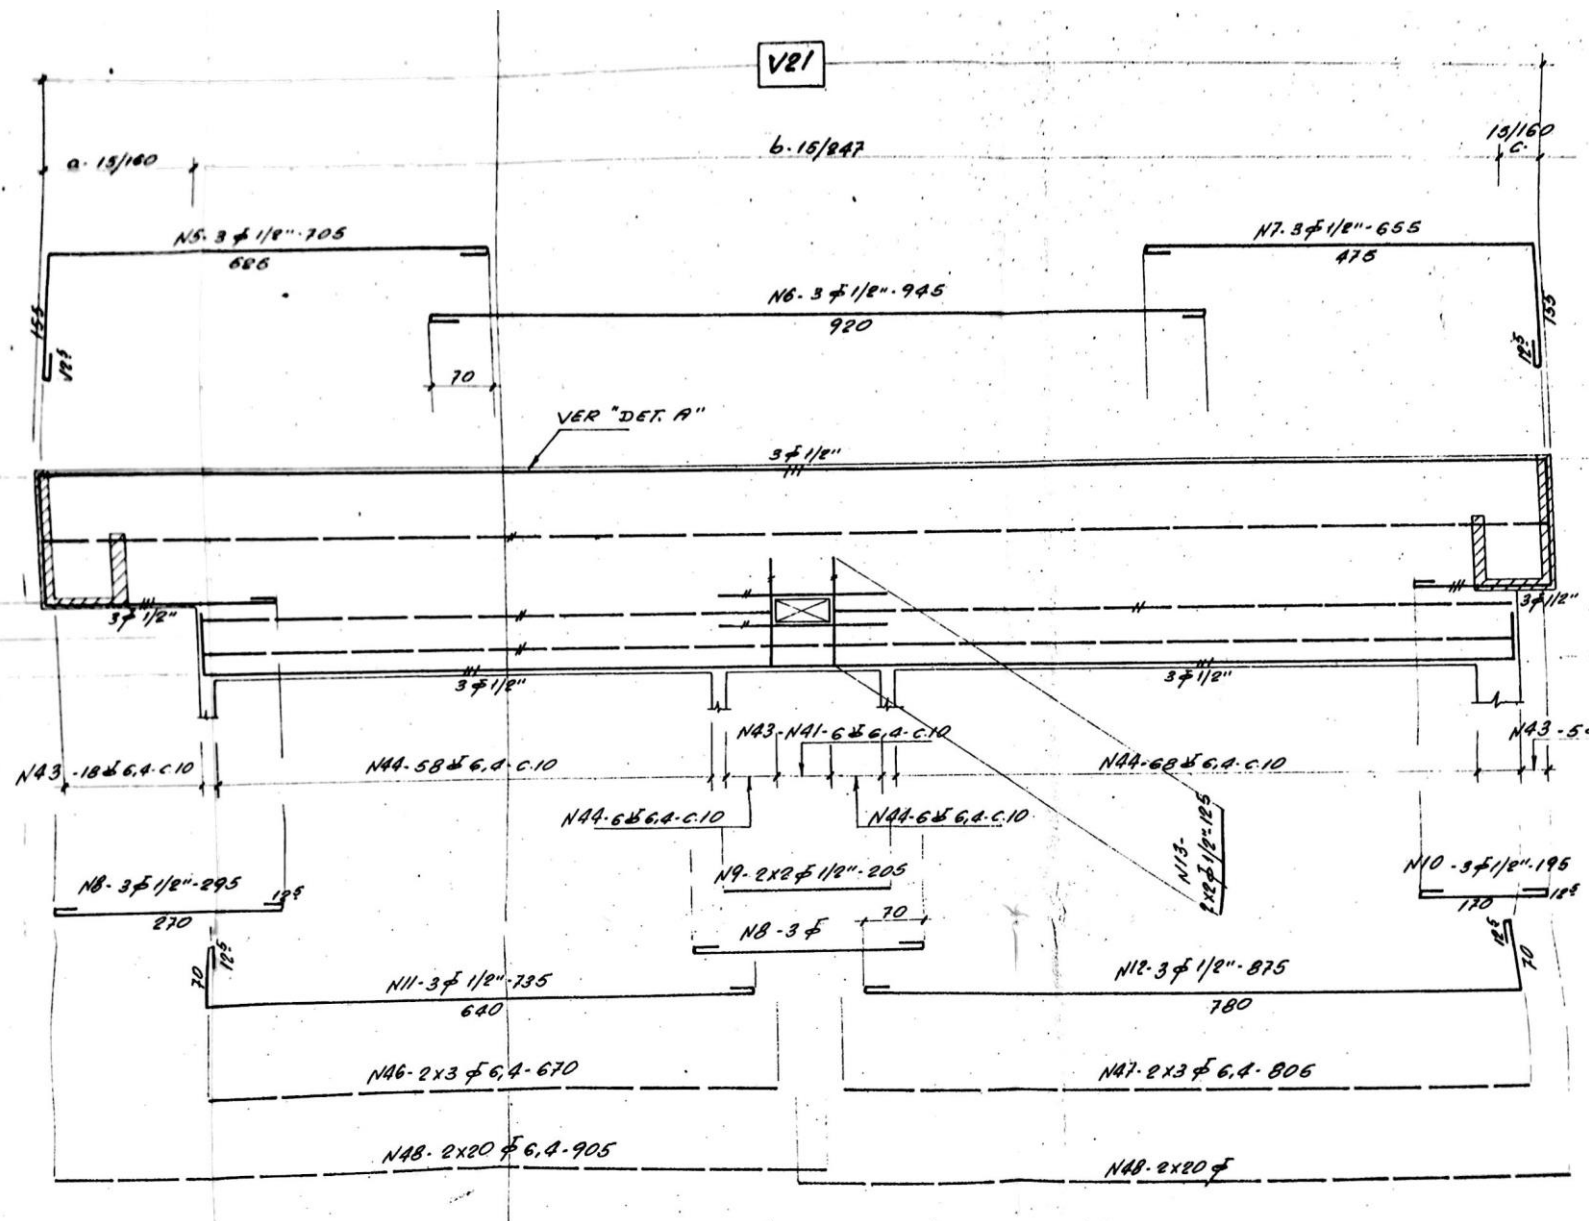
Det. de Armação da Viga da Cobertura - V21
